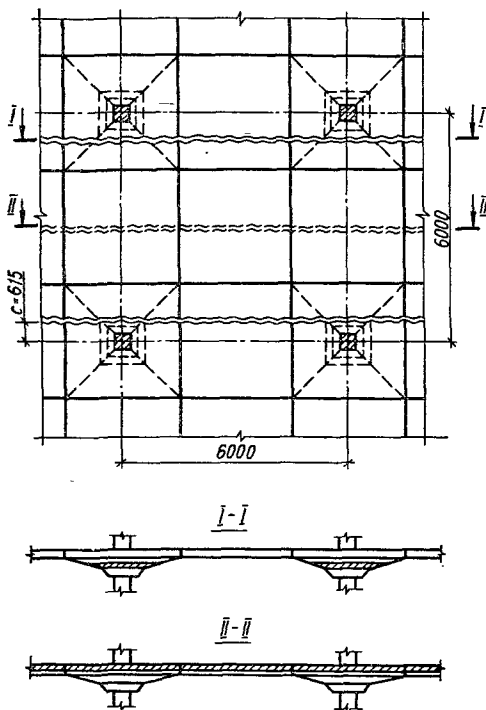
Схема полосового излома перекрытия (в сечениях заштрихованы сжатые зоны бетона).
